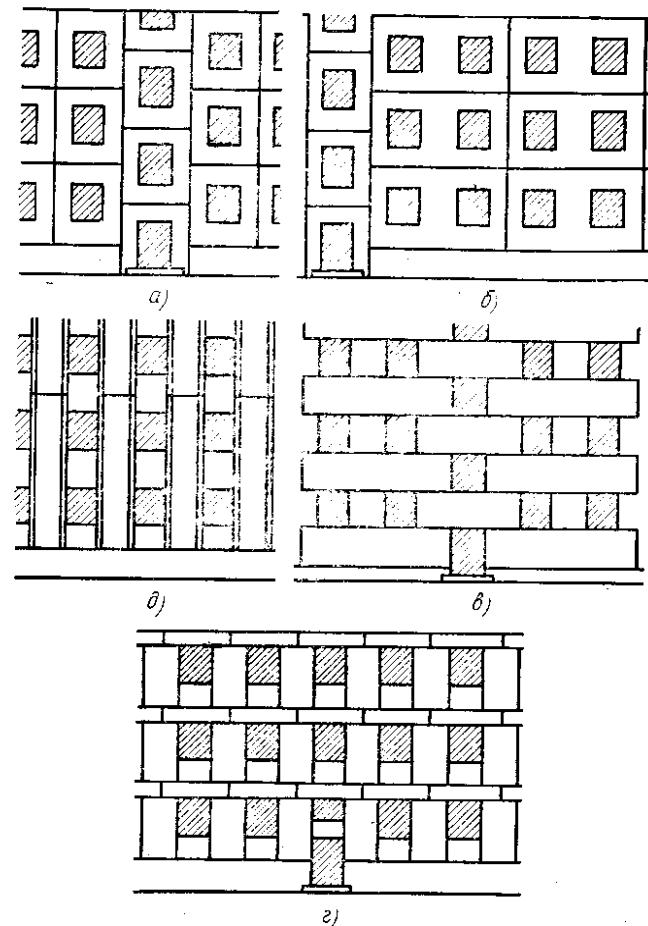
Основные типы разрезок крупнопанельных и крупноблочных стен зданий:
